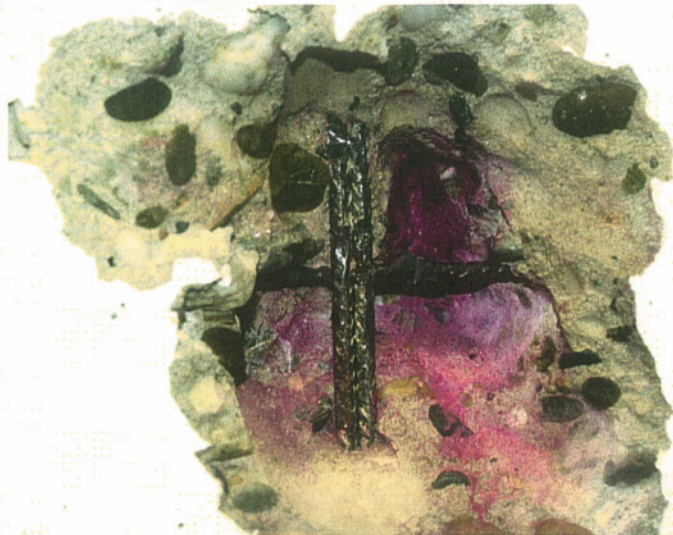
Bewehrungsstahl der Messstelle aus Bild 19
